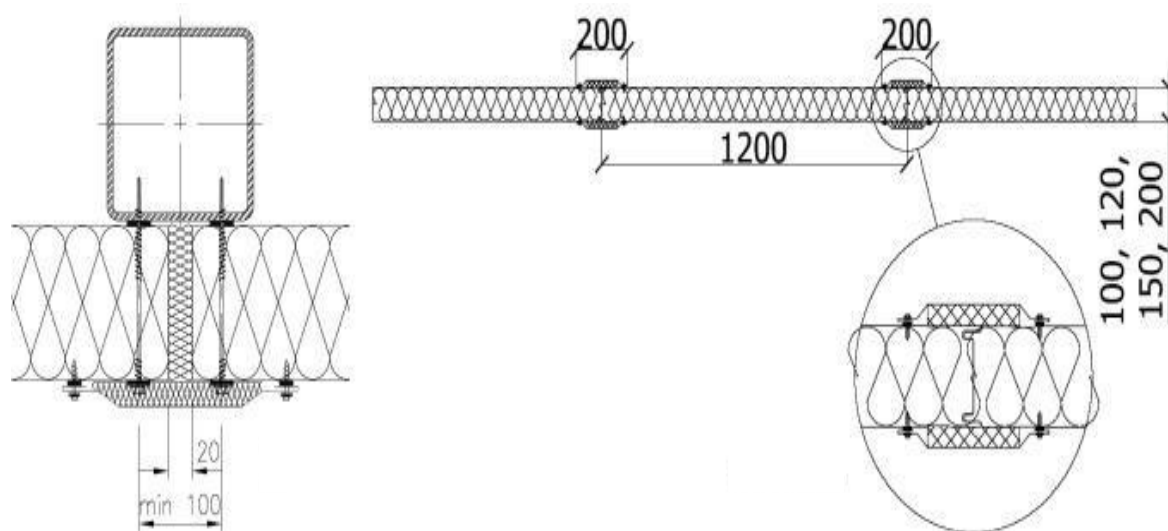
Схема оформления поперечного стыка для защиты от проникновения дыма и газов.
